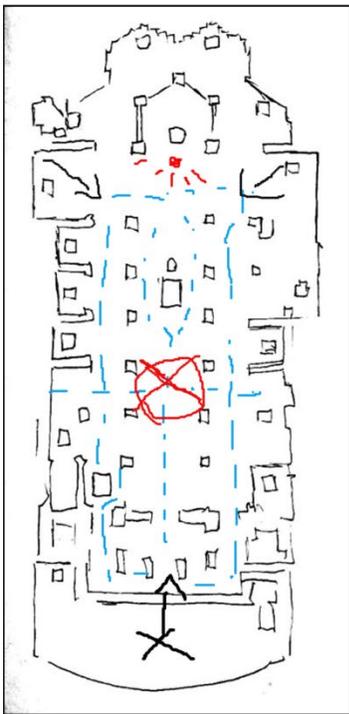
Cartografía. Planta y Alzados de la Casa de Mercado Cubierto: Elaboración Propia 2023
